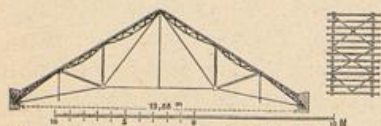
Dachkonstruktion eines Retortengebäudes der Imp.-Cont.-Gas-Ass. in der Gitschiner Strasse No. 19 (früher Hellweg 8).
